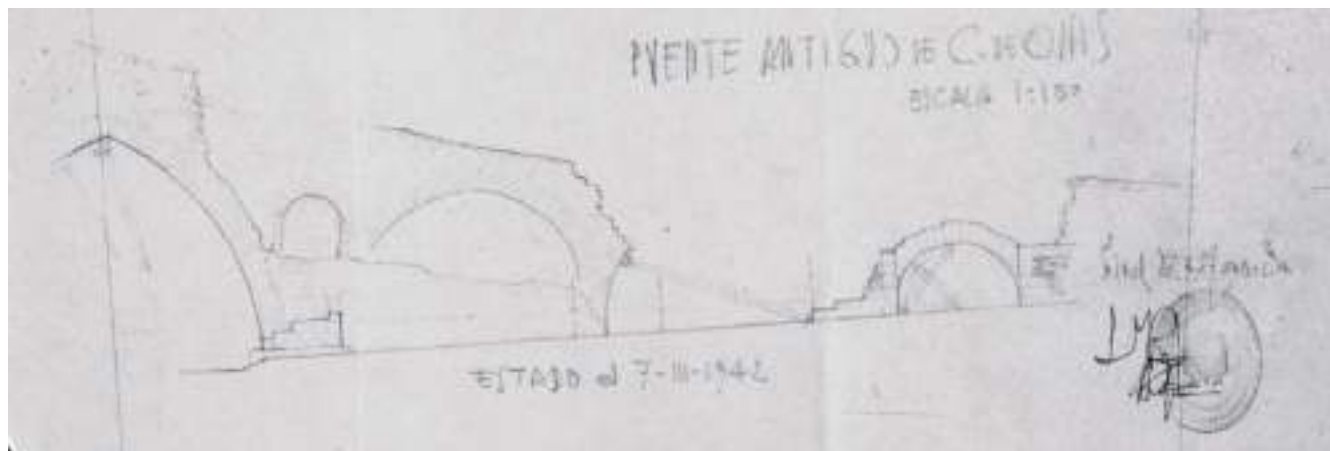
Plano del estado del puente a 7 de marzo de 1942, elaborado por Menéndez Pidal. (Archivo del Ministerio de Cultura)
